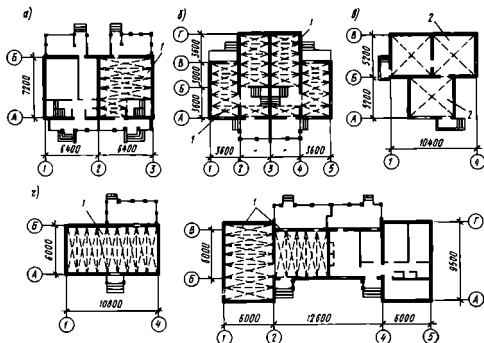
Планы конструктивных схем стеновых остовов малоэтажных зданий:
